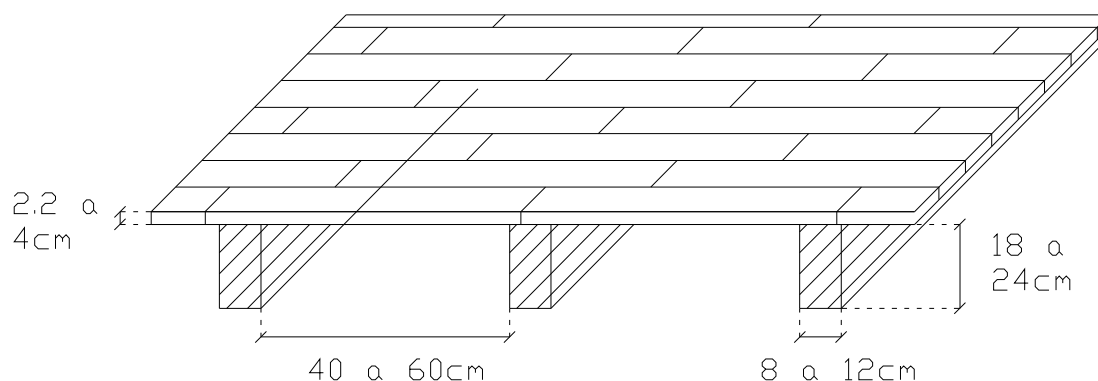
Esquema de pavimento interior sobre espaços não-úteis e exteriores
